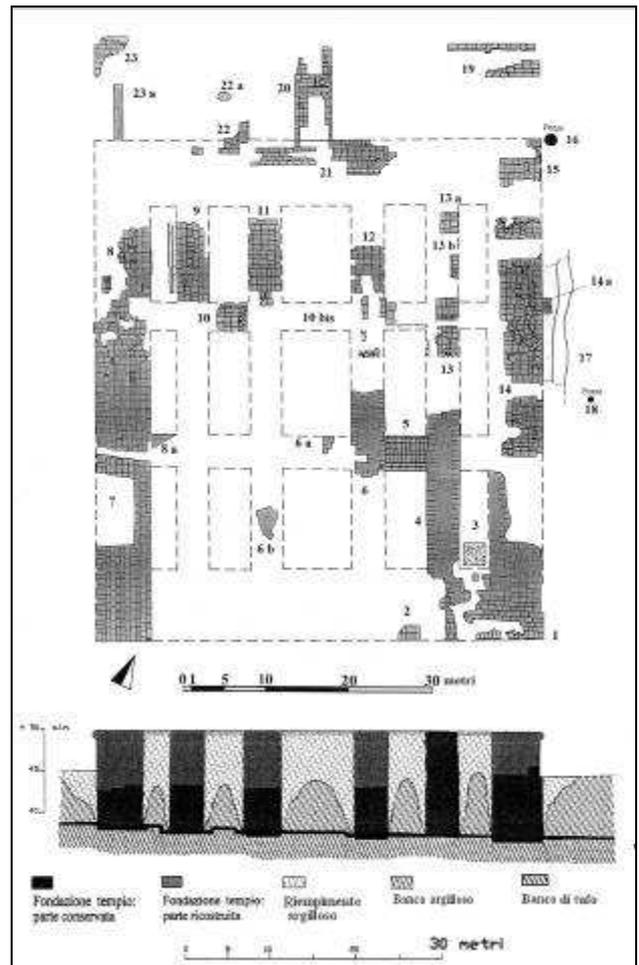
Roma. Tempio di Giove Capitolino. Sopra: planimetria generale dei rinvenimenti presso Palazzo Caffarelli. Sotto: sezione trasversale dei resti conservati della fondazione e del basamento con l'integrazione delle parti mancanti (CIFANI 2008, rielab. dell'autore)
